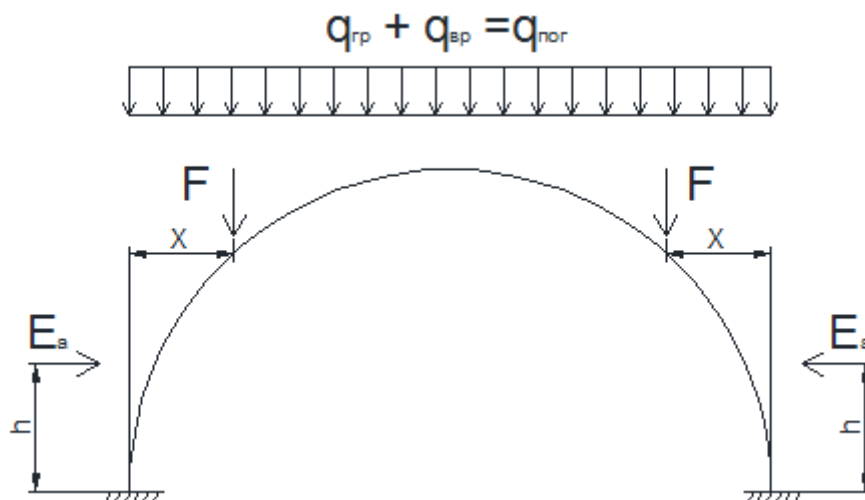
Расчетная схема для нормальной работы конструкции на расчетные нагрузки (рисунок авторов)
